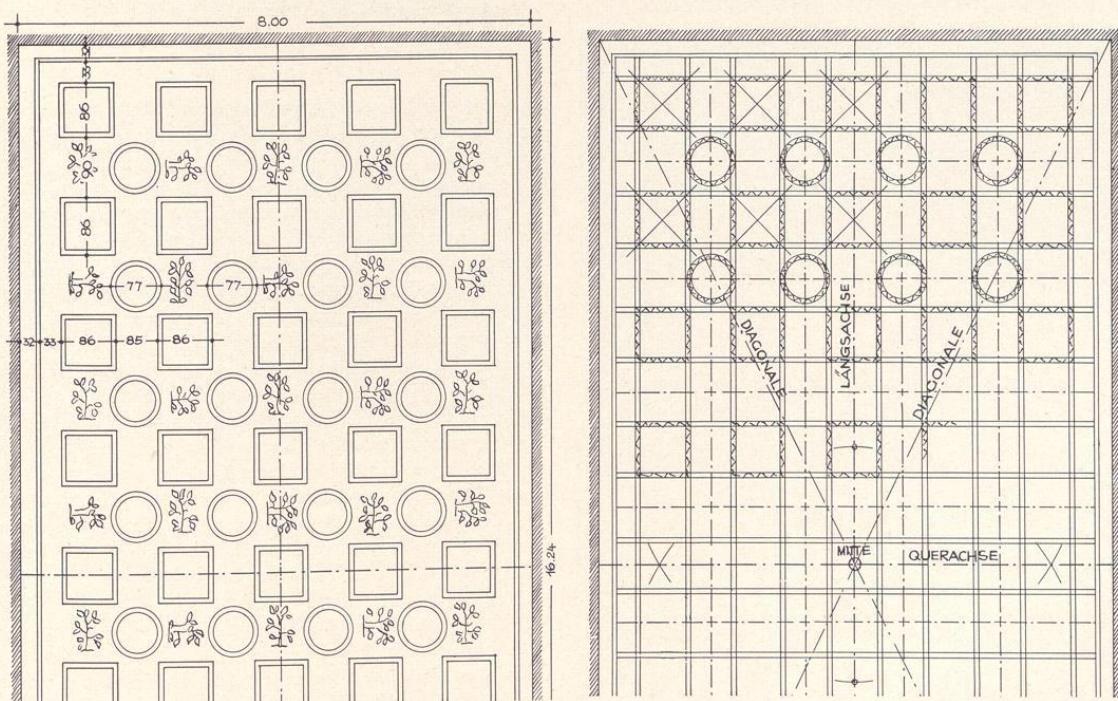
Stuckdecke von Bild 487, links im Grundriß, rechts der Aufriß an der Decke mit den zur Ausführung erforderlichen Hilfslinien
